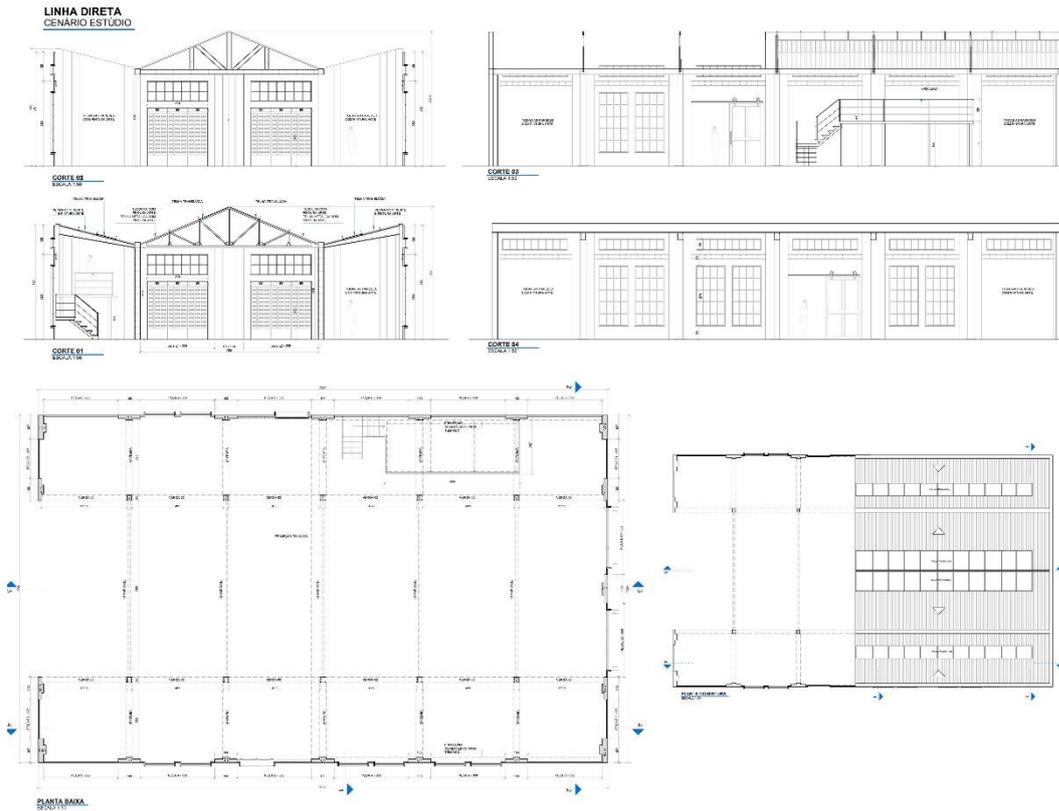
Desenho técnico – cortes. Fonte: arquivo pessoal.
